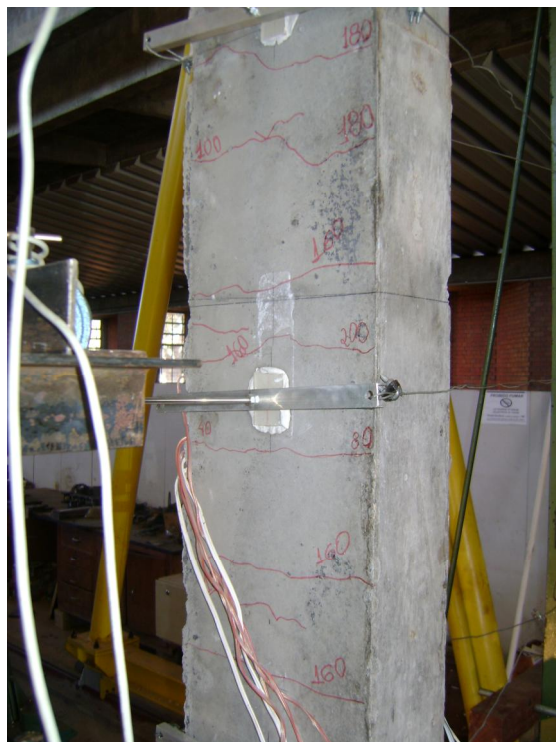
Fissuras do pilar PFN 40-2,5
